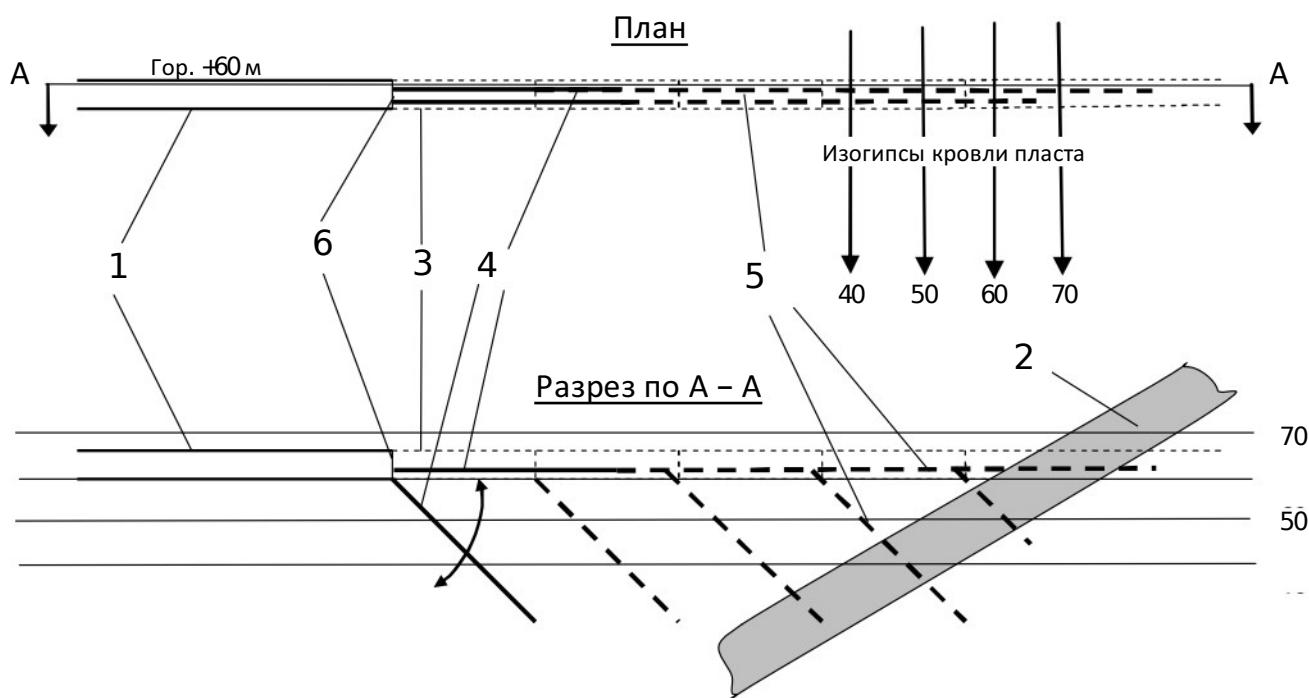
Схема бурения разведочных скважин для уточнения положения пласта относительно вскрывающей выработки, приближающейся к пласту со стороны кровли диагонально к его простиранию:
